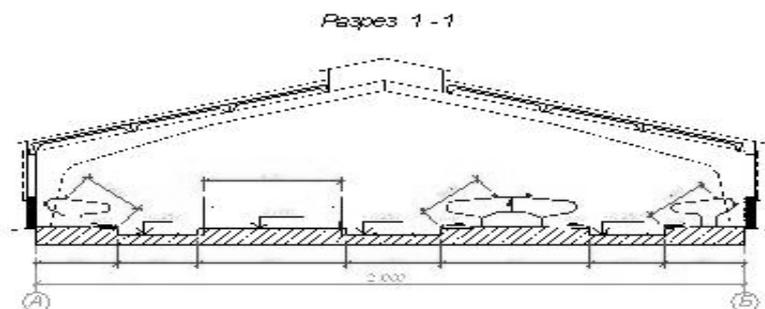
Коровник из сборных полурамных железобетонных конструкций
